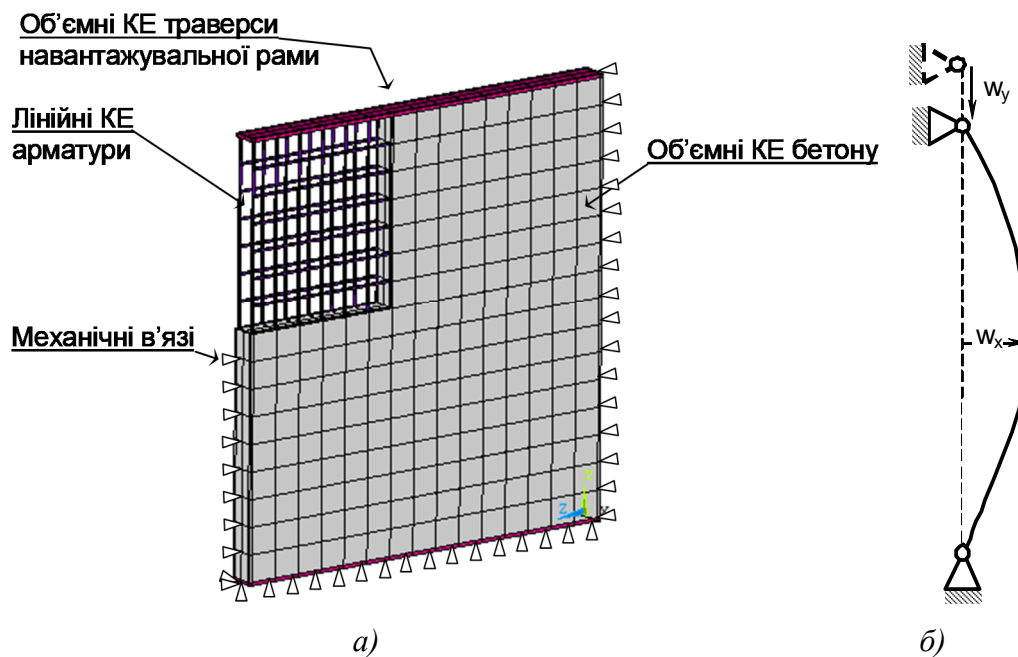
Кінцево-елементна схема залізобетонної стіни та накладеній на її вузли механічні в'язі (а) та розрахункова схема закріплення стіни (б).
